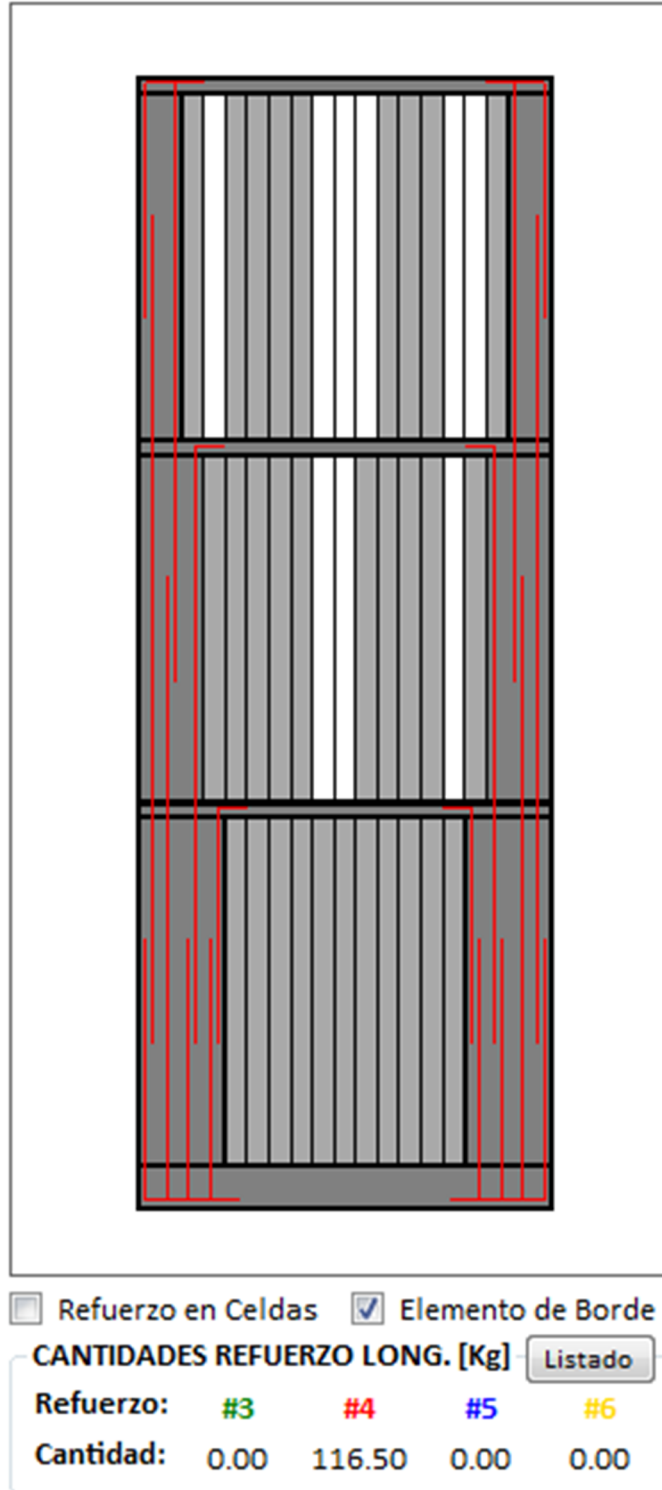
Ventana de alza de muro para elemento de borde de sección variable.
